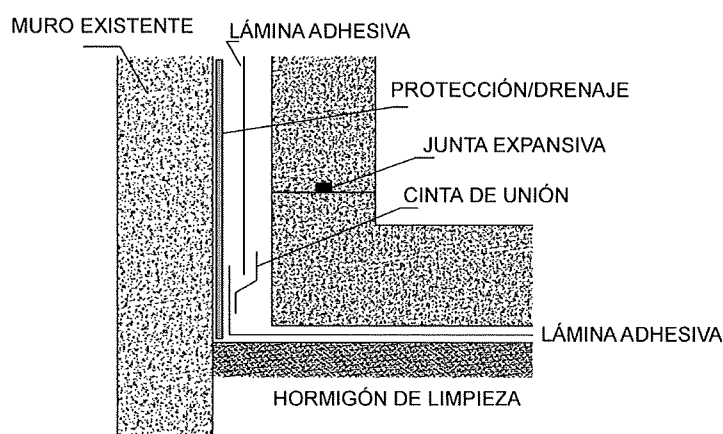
Sección tipo de aplicación de láminas adhesivas previas al hormigonado.
